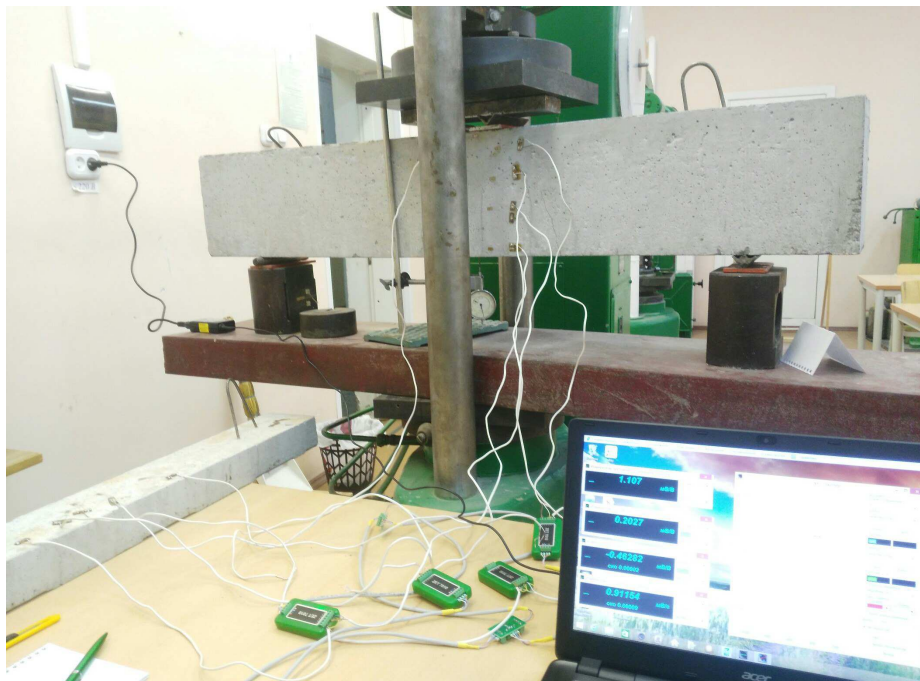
Испытательная установка с железобетонной балкой
